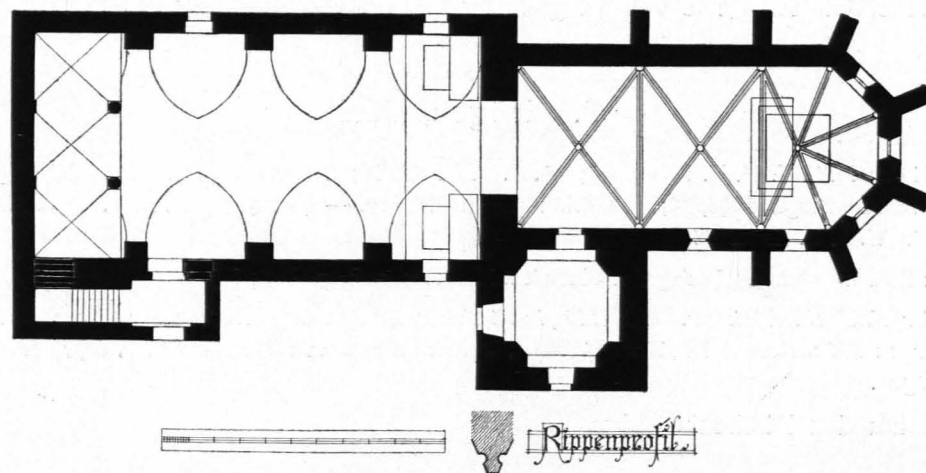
Strögen, Pfarrkirche, Grundriß 1 : 300 (S. 346)
